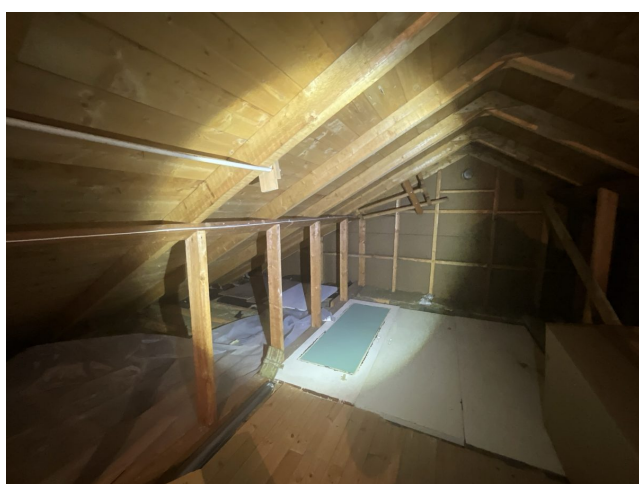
Loftrom med synlig takkonstruksjon og isolasjon
